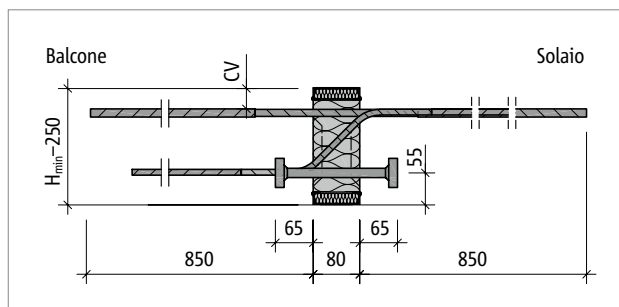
Schöck Isokorb® T tipo K-M12: sezione del prodotto
